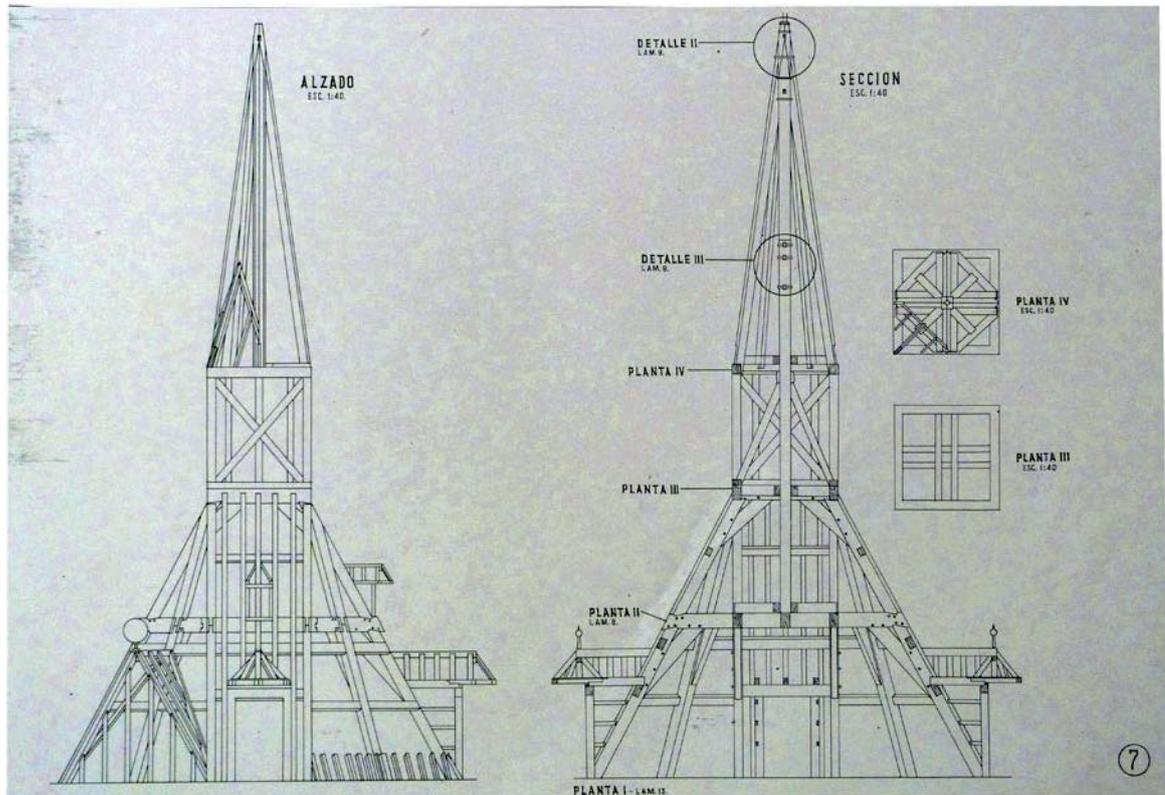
Alzado y sección del chapitel, según Vidaurre. A.D.A.P.N. Plano 415
